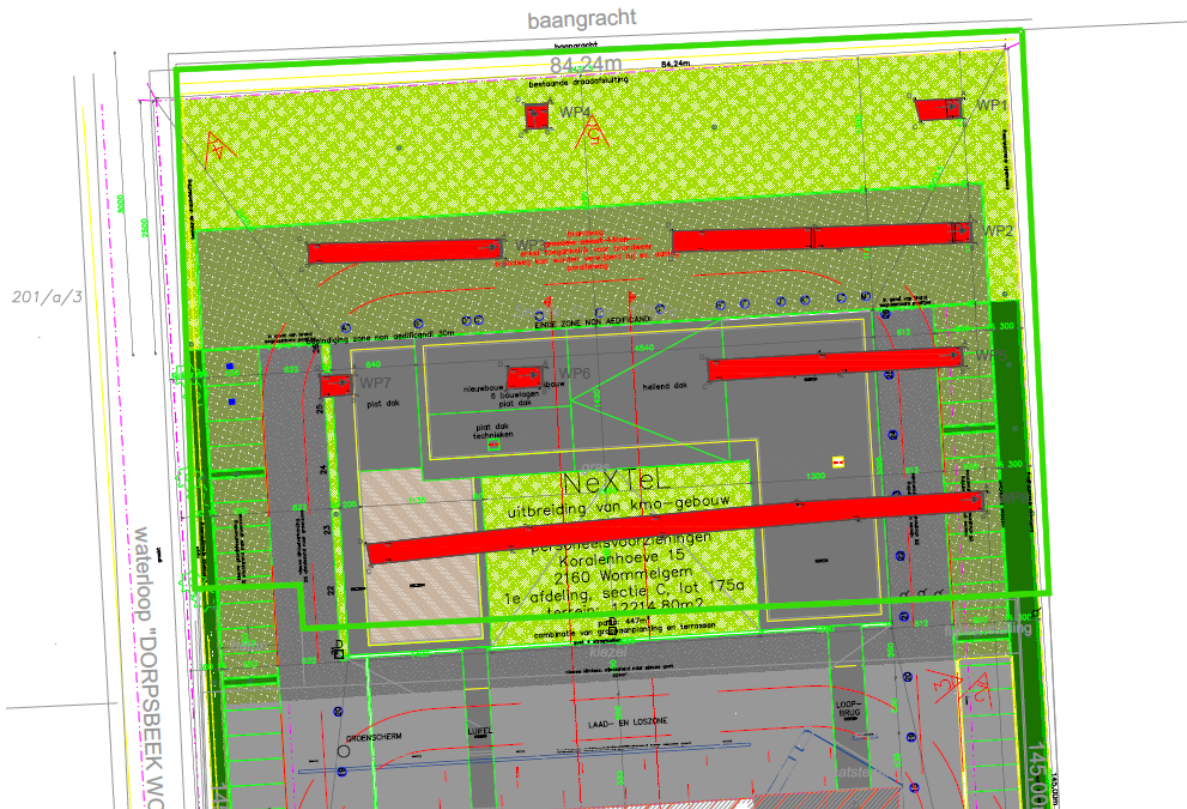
Uitbreiding ten noorden van het reeds bestaande gebouw
